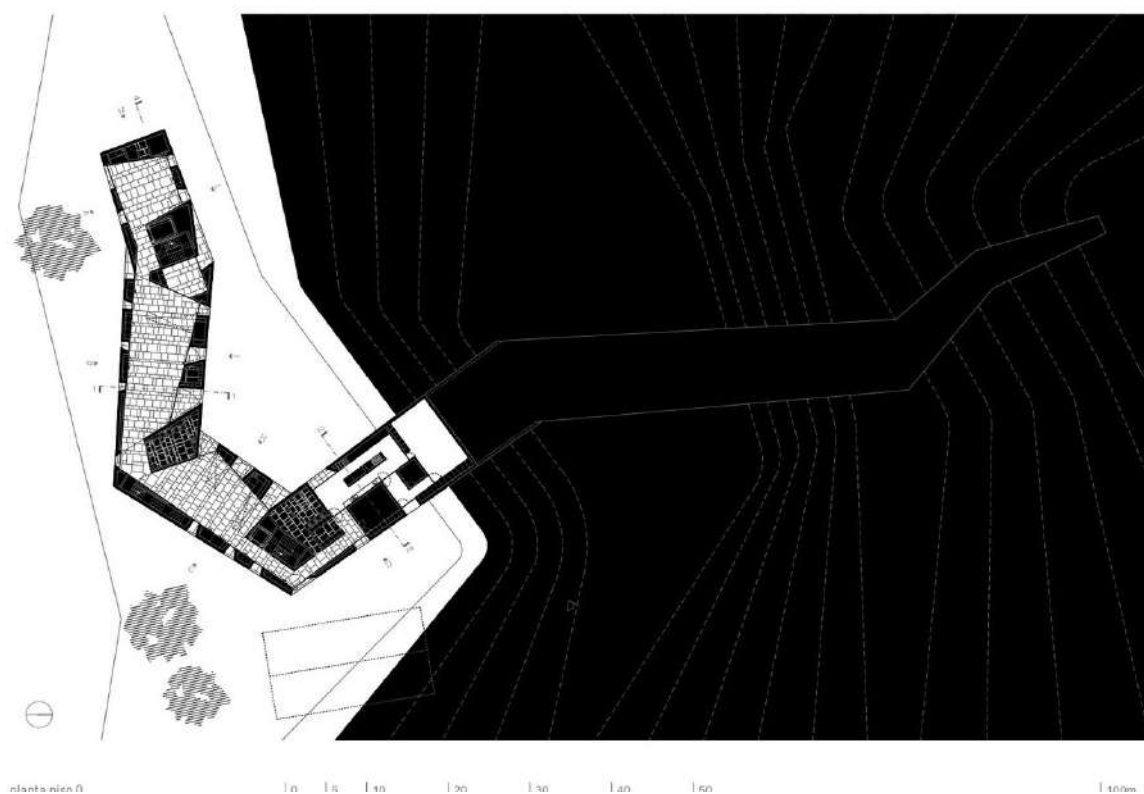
Plano distribución Planta 0. Fuente: www.archidaily.com
